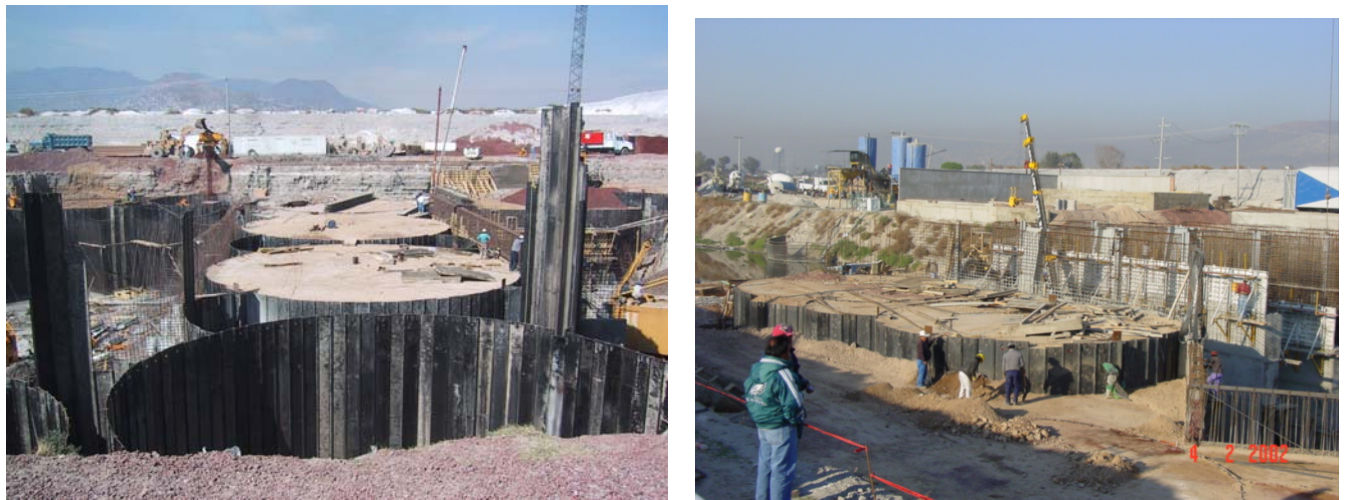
, Proceso constructivo de la planta de Gran Canal
